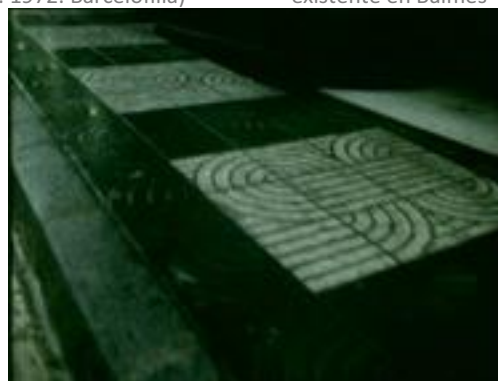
> detalle del pavimento de la calle Jaume I (Ballesteros 1971)
